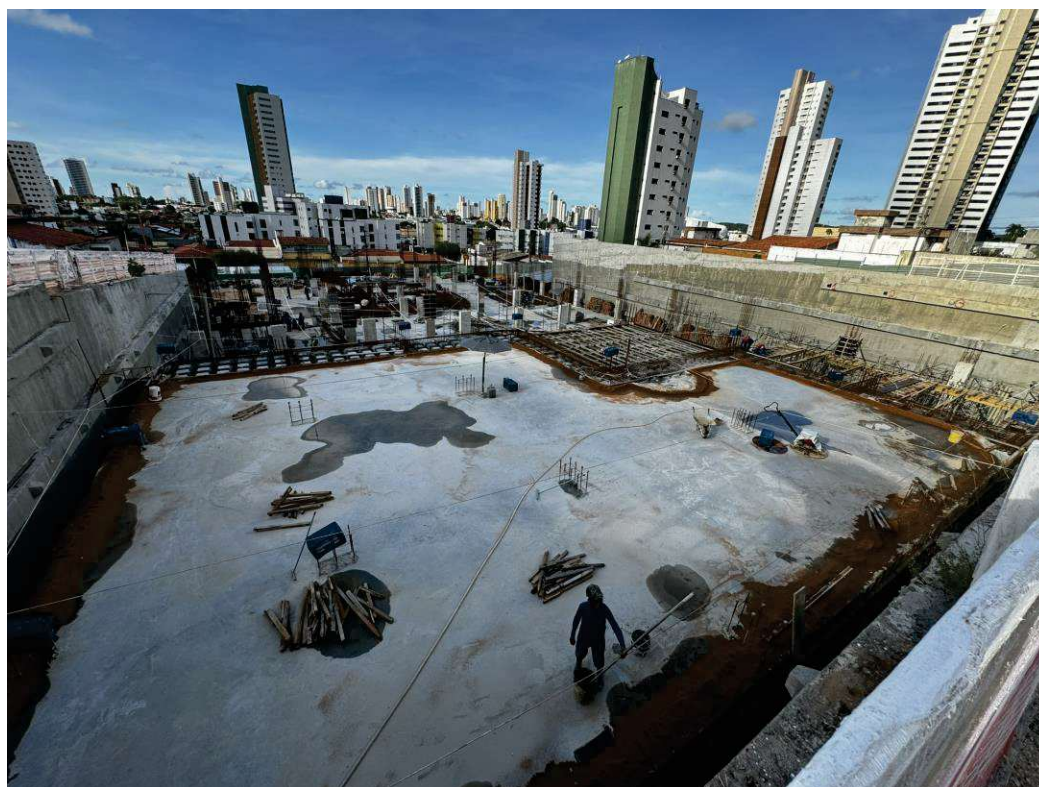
Local da laje do segundo subsolo um foi concretada parte da laje de cobertura do segundo subsolo.
